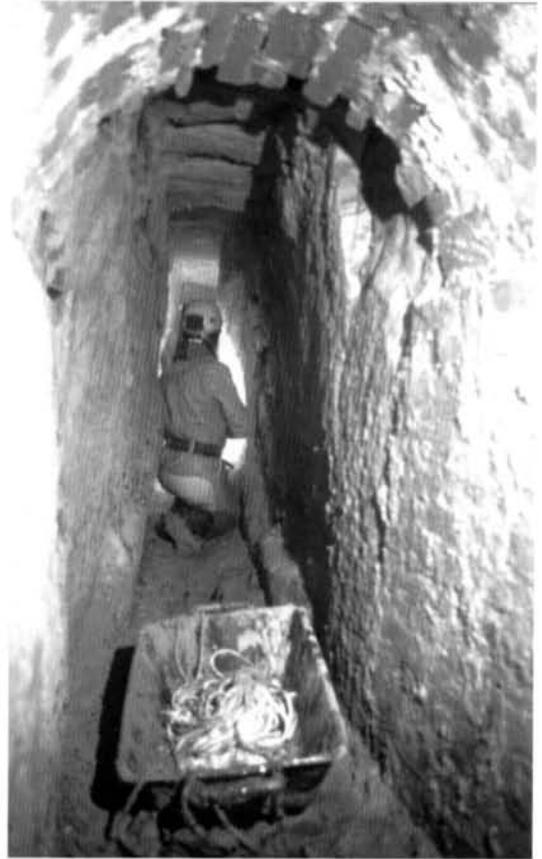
lavori di disostruzione all'interno della sorgente denominata "Trasversale" (foto degli Autori).
